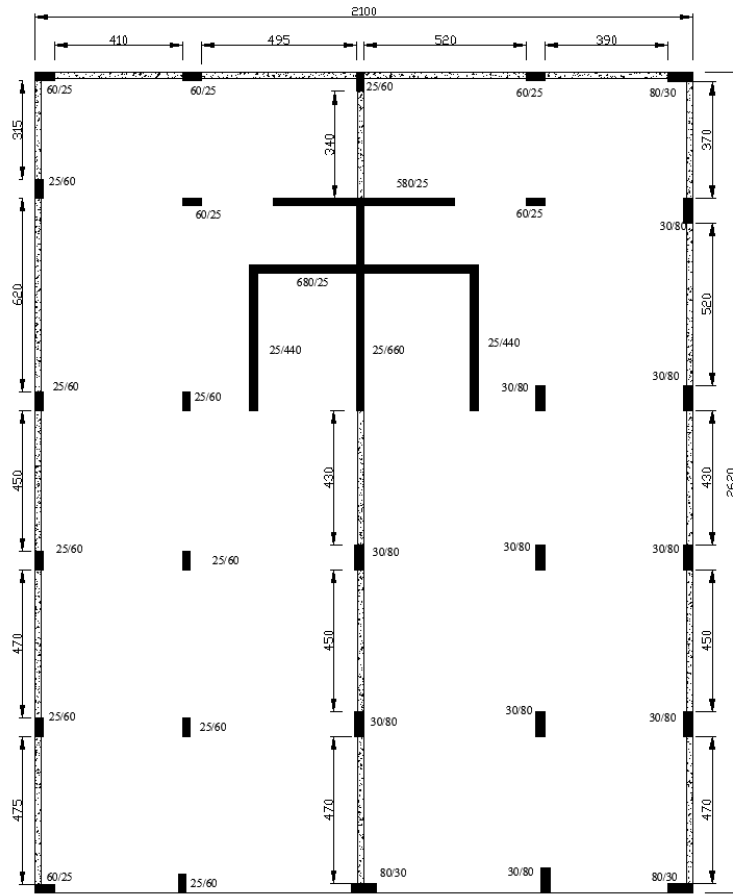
BNG-10-4-6 binasının kat planı [SERU Structural Engineering Research Unit, 2011]
